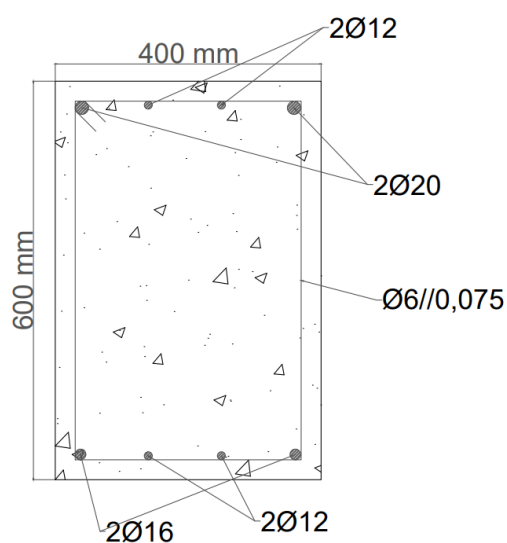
Secção Transversal da Viga 1 no piso 14
